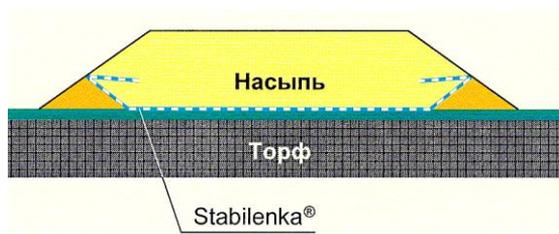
Пример применения армирующего материала Stablenka® для обеспечения устойчивости насыпи на слабом основании
